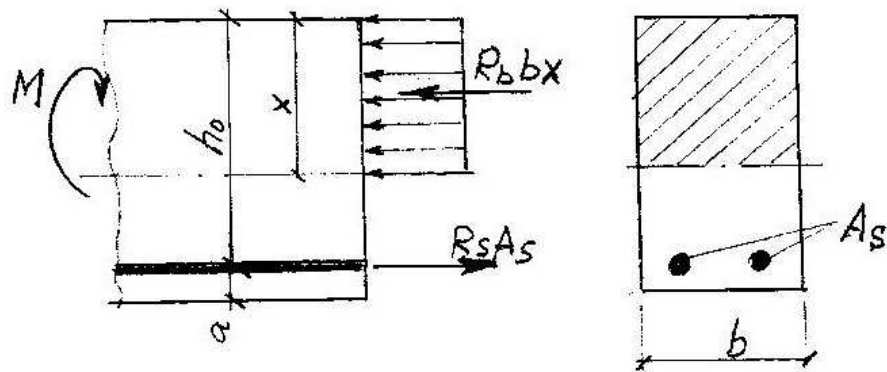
Схема внутрішніх зусиль в нормальному перерізі
